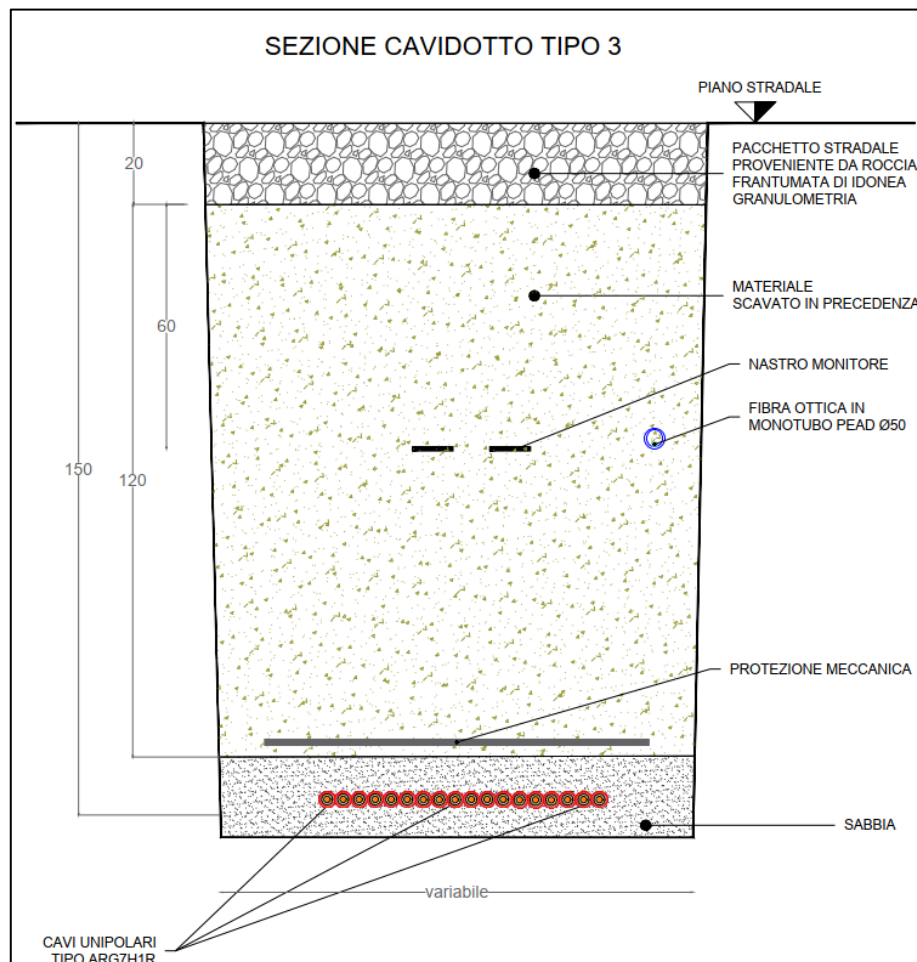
Sezione di posa cavidotto MT a 30 kV – tipo 3
